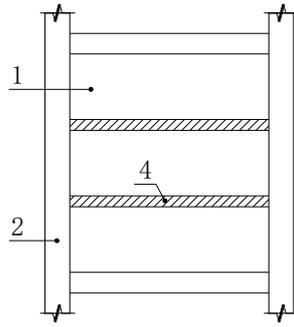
叠合板的预制底板分离式接缝布置示意
